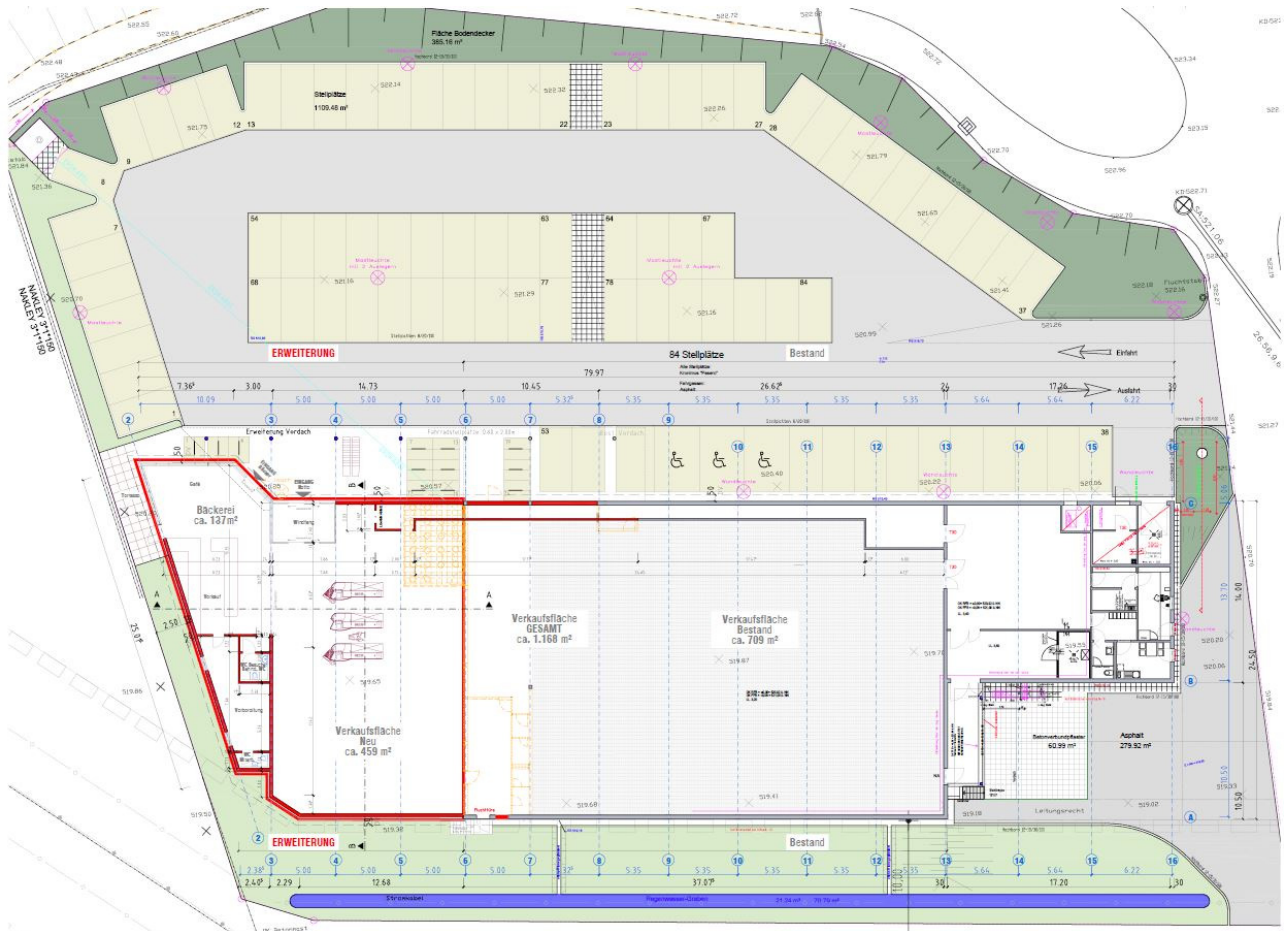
Grundriss Entwurf Architekt Vögele, Stand 23.05.2019
